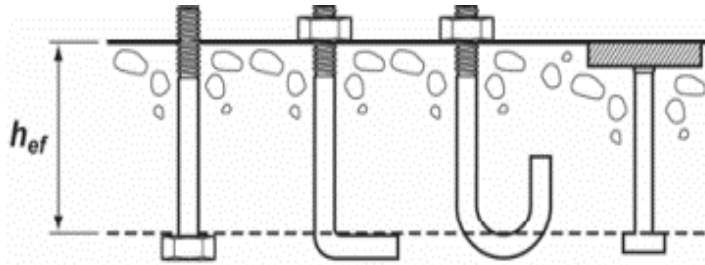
Anclajes preinstalados antes de la colocación del concreto.
